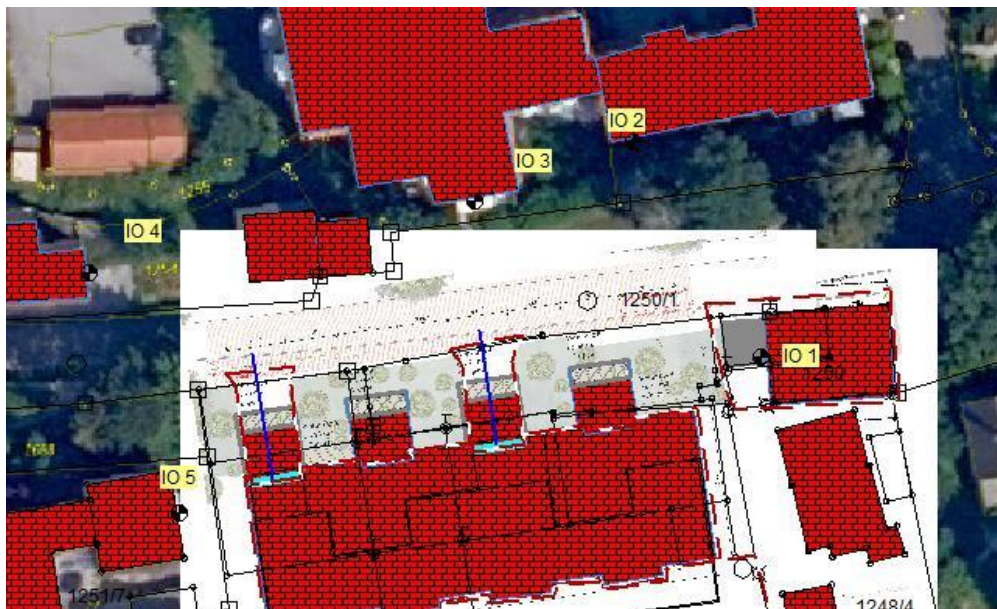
Lageplan mit Kennzeichnung des Immissionsortes IO 1 – IO 5
